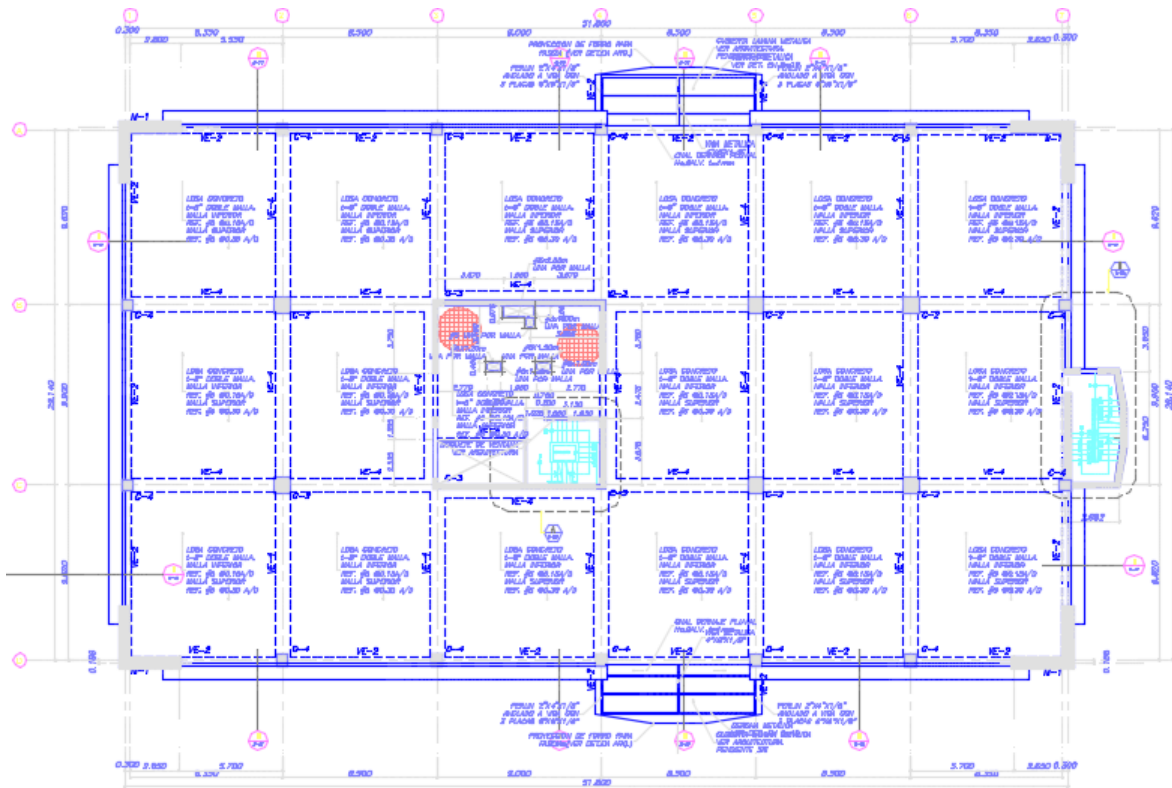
Planta Estructural Entrepiso, Segundo Nivel.
